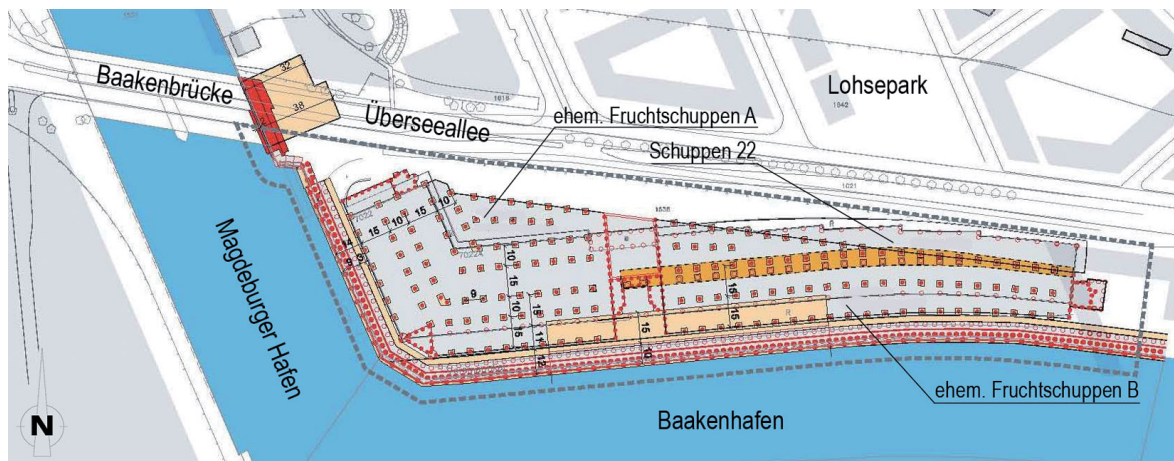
Lageplan Baufeld mit Restriktionen aus der Altbebauung
